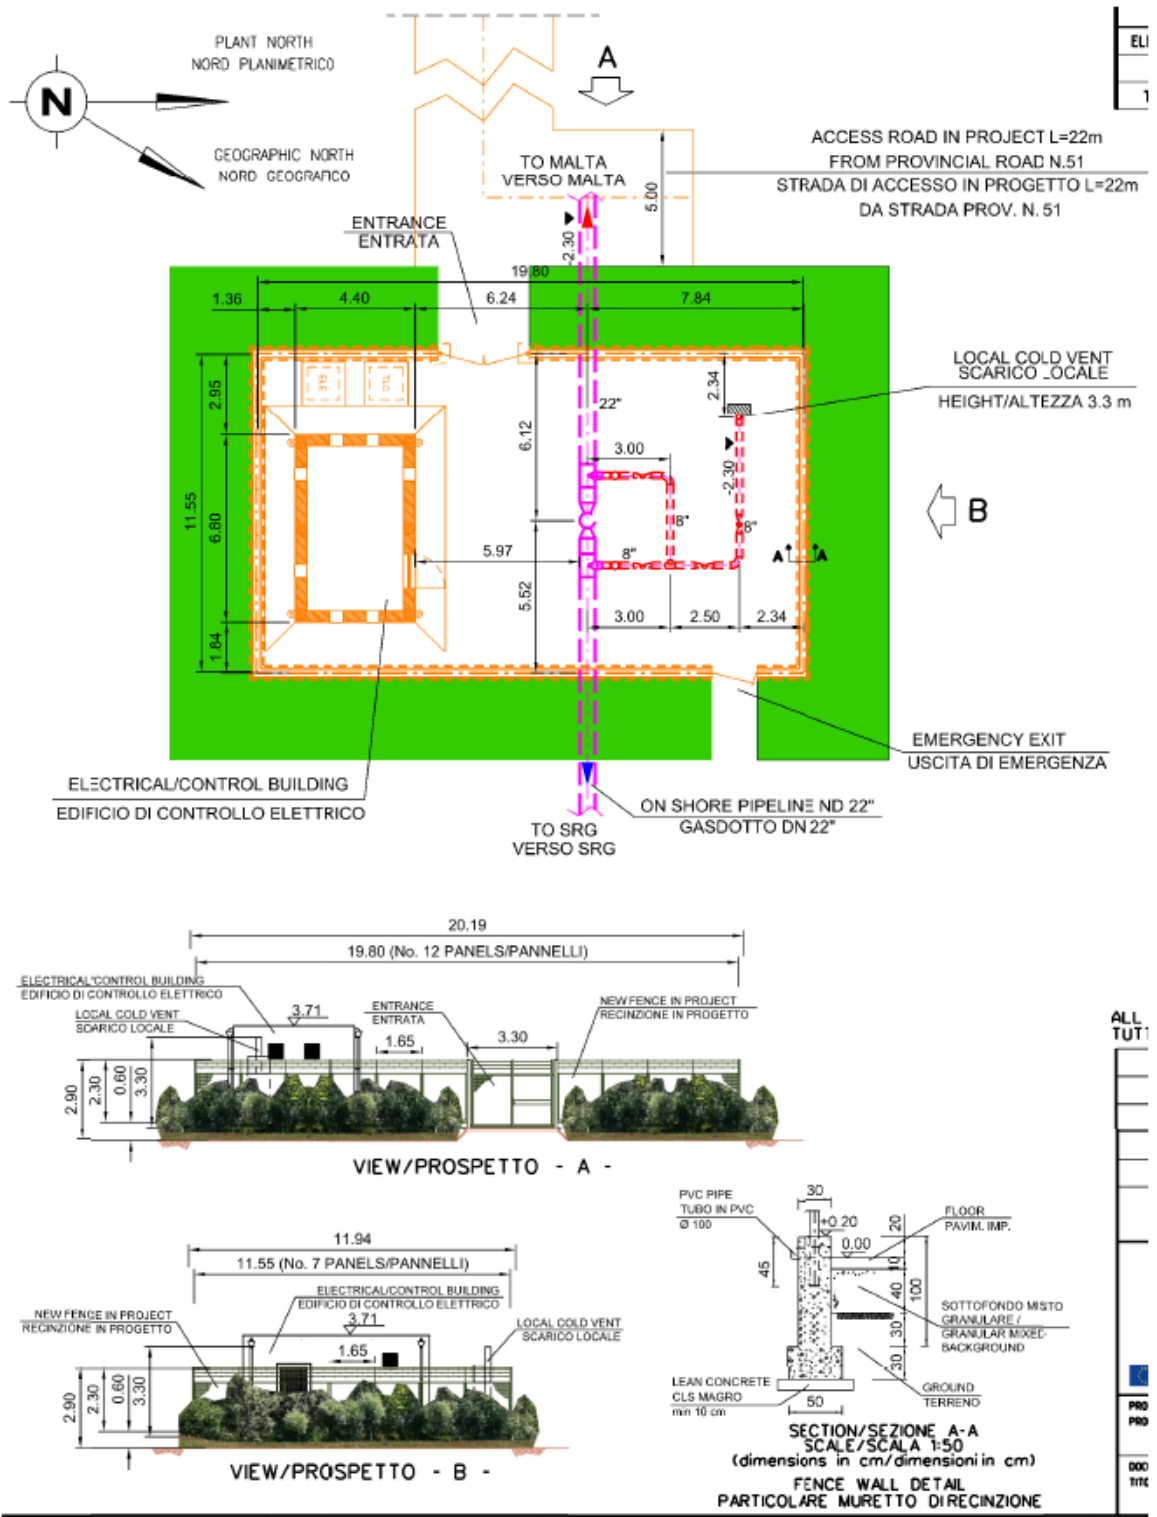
Punto di intercettazione di linea 2 – Planimetria e prospetti
